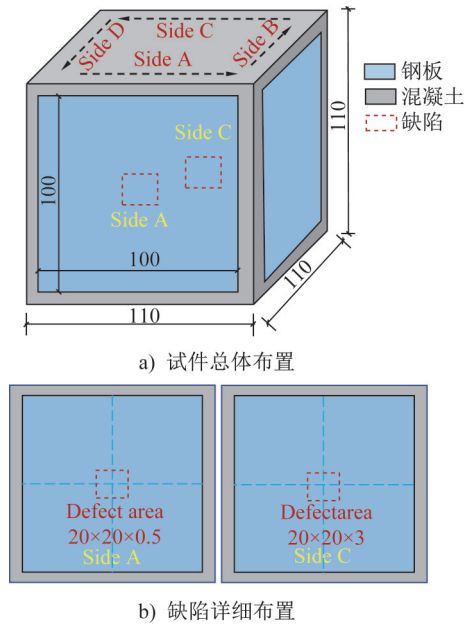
钢板-混凝土界面剥离试件示意图(单位:cm)
